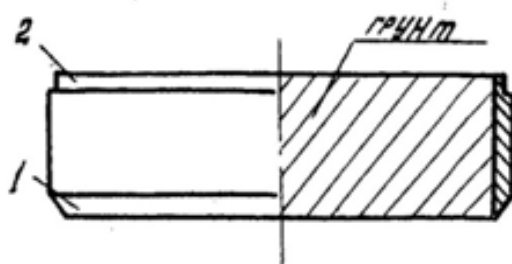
Режущее кольцо. 1 – режущая кромка; 2 – кольцевая выточка.
